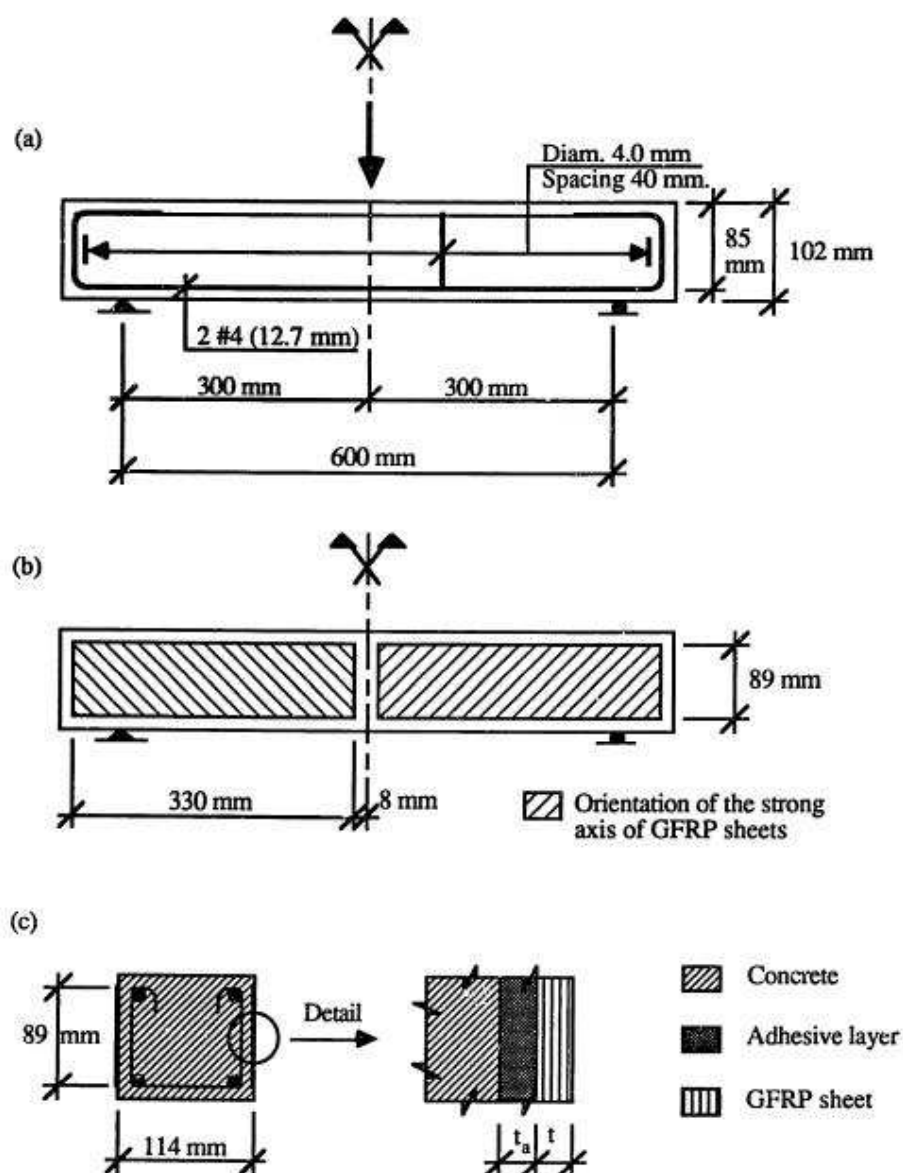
Geometría y disposición de barras y refuerzos en las vigas ensayadas por Berset.
